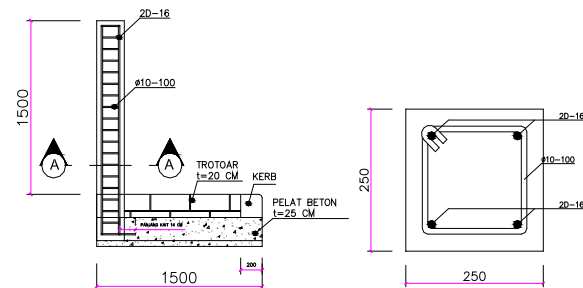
Potongan Memanjang Rencana Modifikasi Desain
